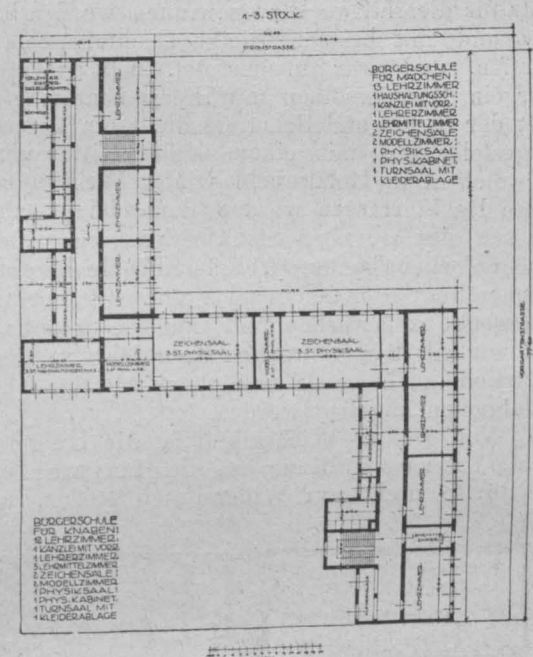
Grundriß des 1. bis 3. Stockes zu Abb. 16.
